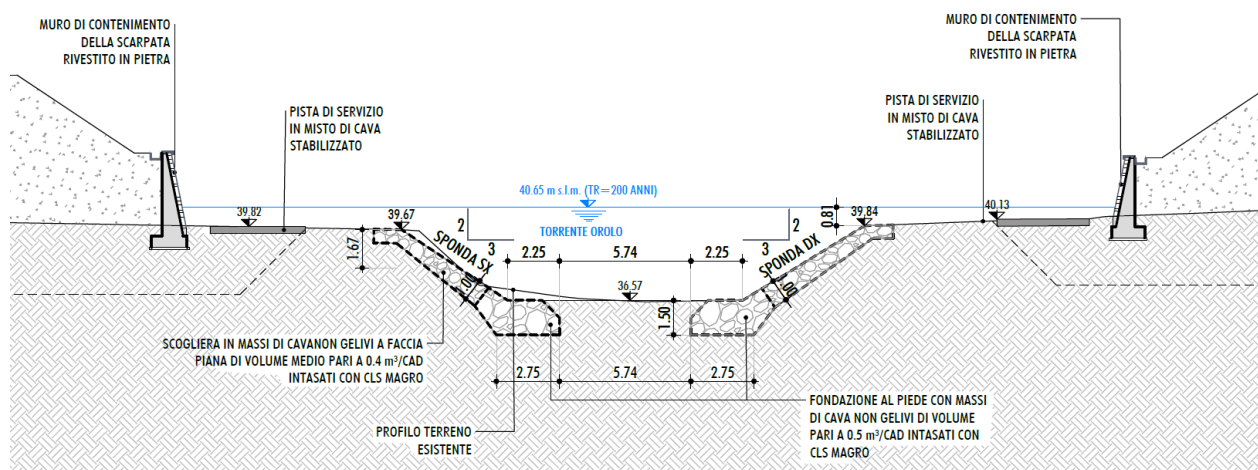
TORRENTE OROLO: SEZIONE B-B FUORI DALL'OMBRA DEL PONTE (VISTA DA MONTE)
